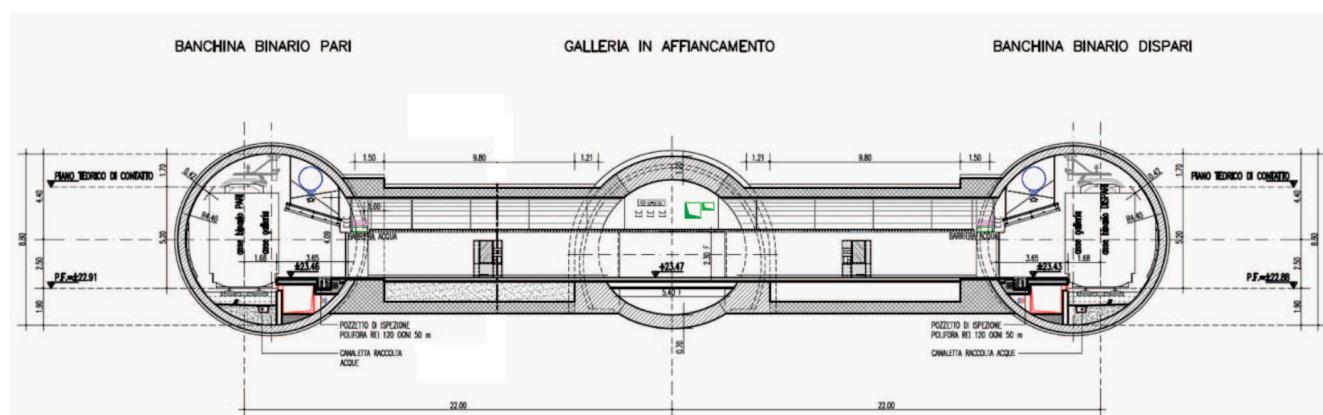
Sezione tipo della fermata sotterranea Boccetta - Piano binari.
